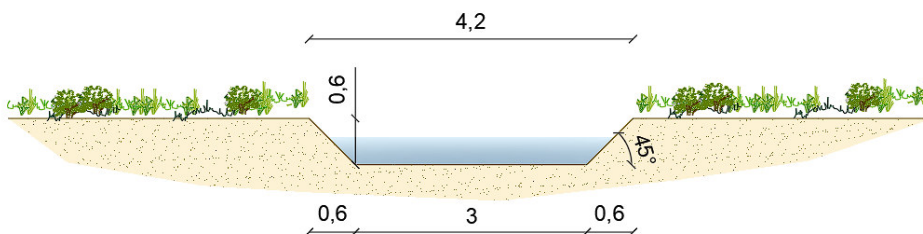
Sezione trasversale del canale in progetto "Tipo 3"
